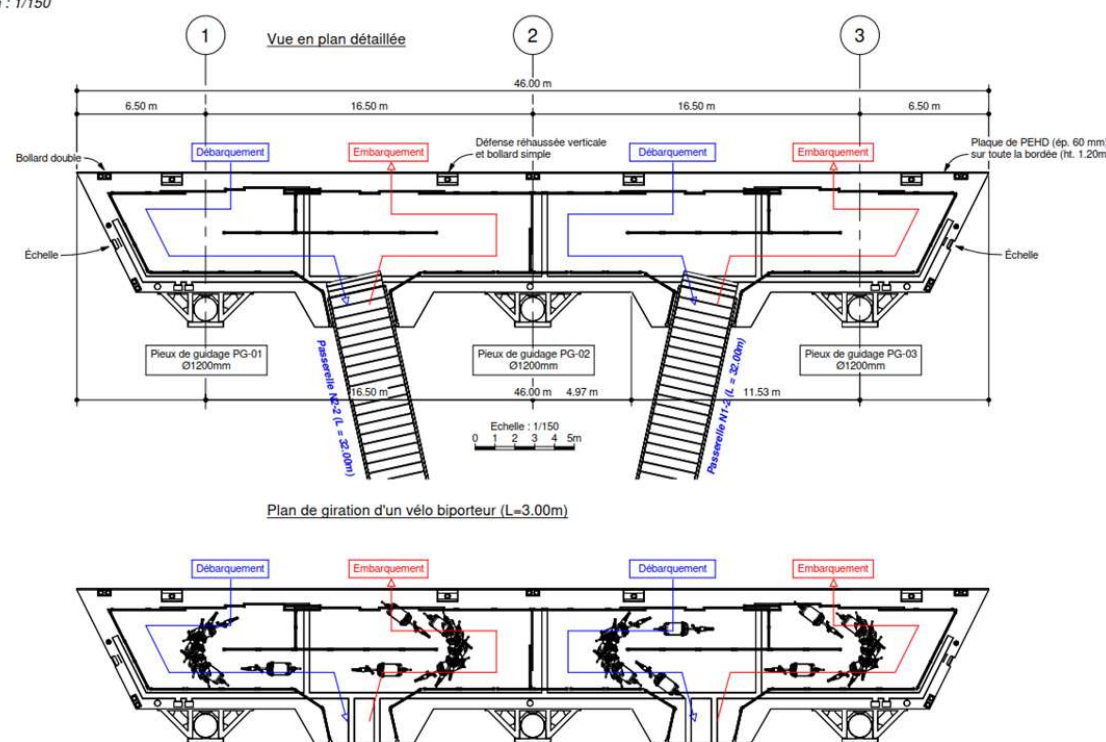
Vue en plan détaillée du ponton (Source : AVP)
